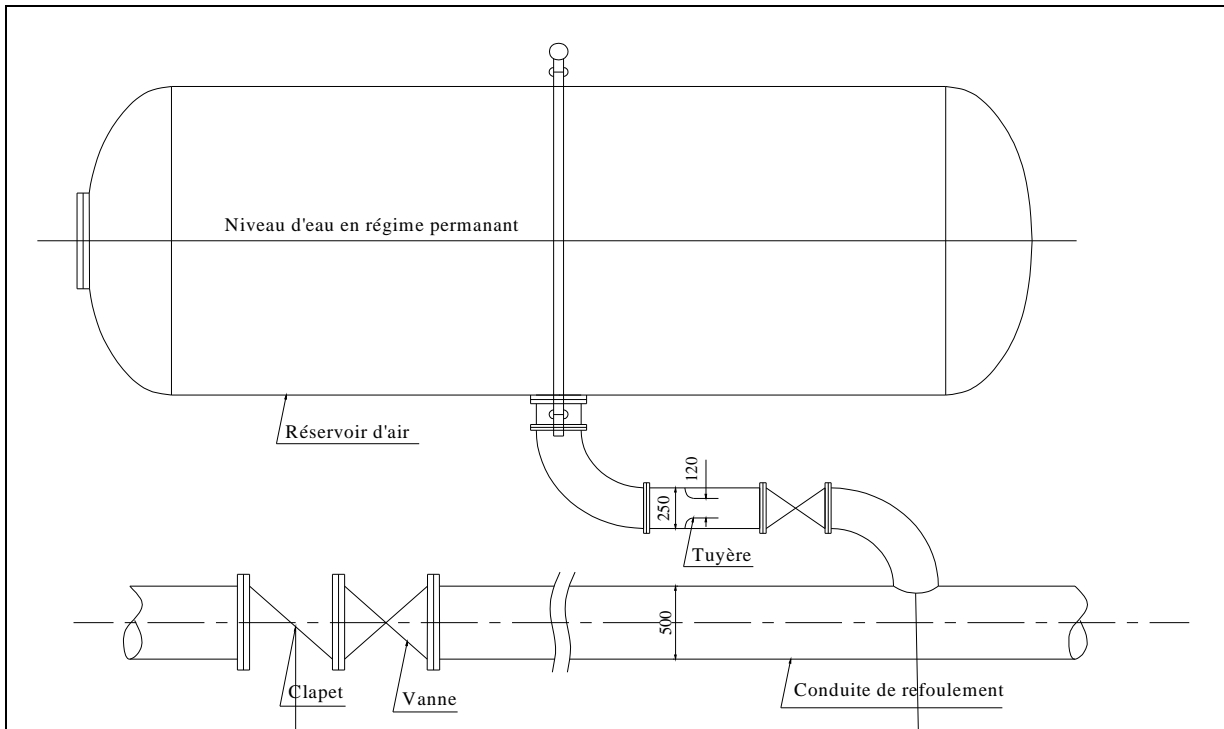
Schéma d'installation du réservoir d'air, vanne et le clapet
